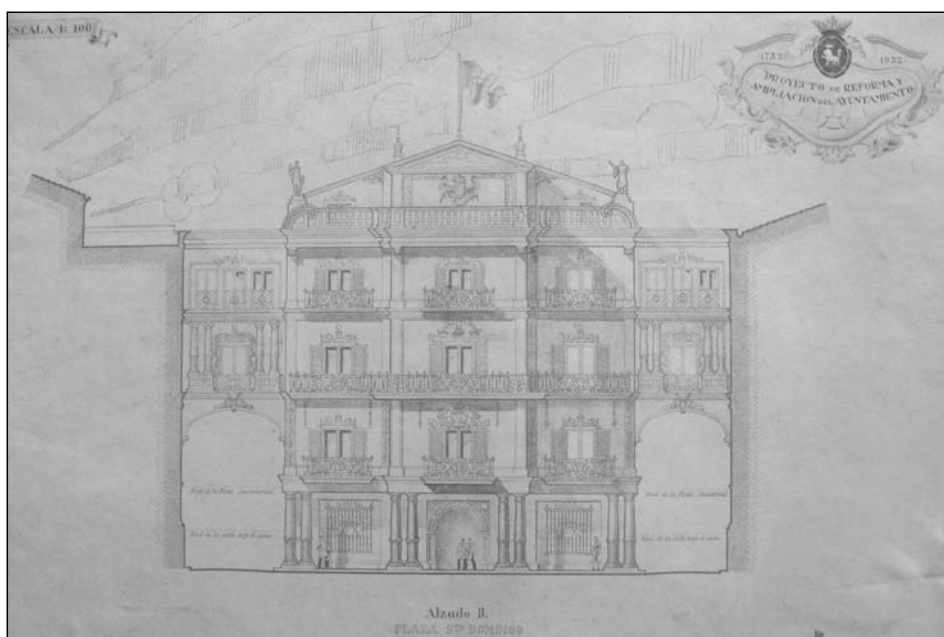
Proyecto de reforma y ampliación del Ayuntamiento. Eugenio Arraiza. Alzado B. Fachada asomada a la Plaza de Santo Domingo. AMP
